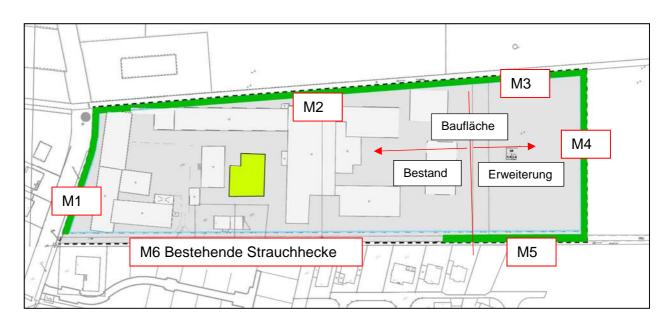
Konzept Bebauungsplan (unmaßstäblich)
